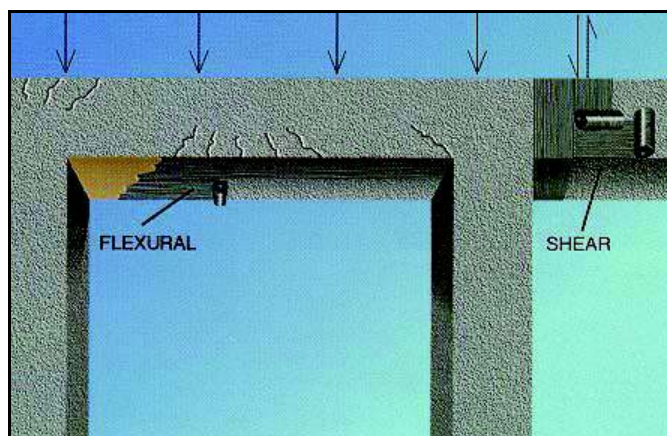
Reforço de vigas à flexão e ao cisalhamento. Fonte: ABCP (2009).
